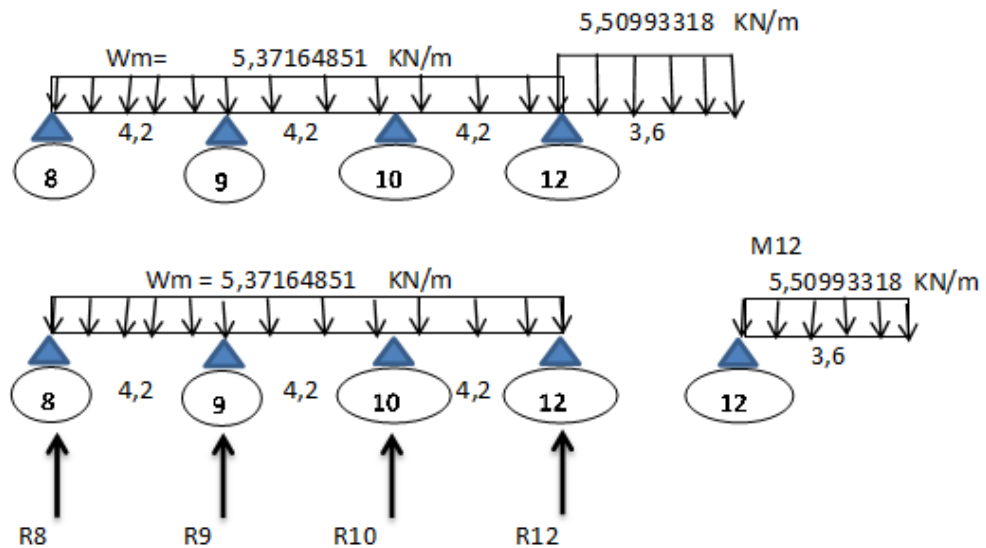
Modelo matemático de viguetas tipo 1, carga muerta actuante
